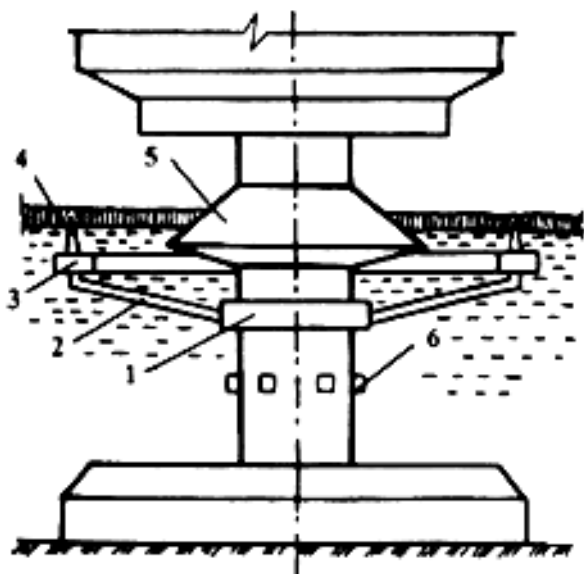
Схема ледорезного пневматического устройства для защиты платформ типа монопод
